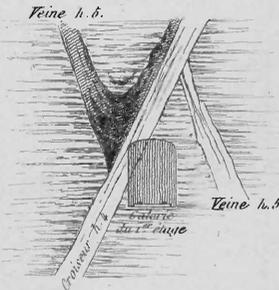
Croisement d'une des veines du Chat par le 2^e croiseur. Coupe horizontale.
